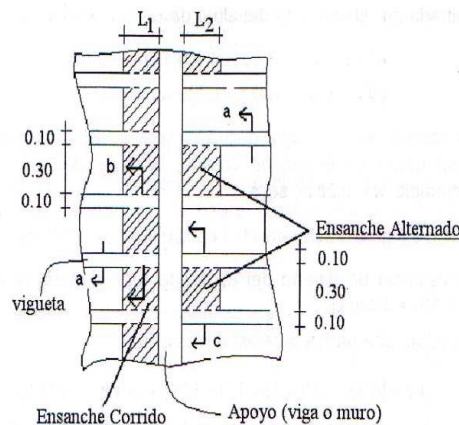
Detalle de ensanche alternado y ensanche corrido.
